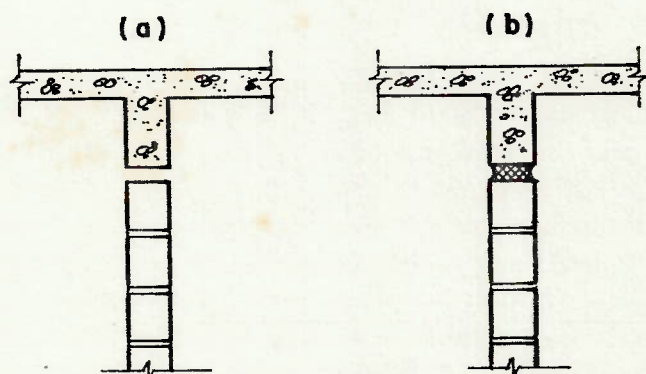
Desvinculação entre a parede fissurada e o componente estrutural superior:
